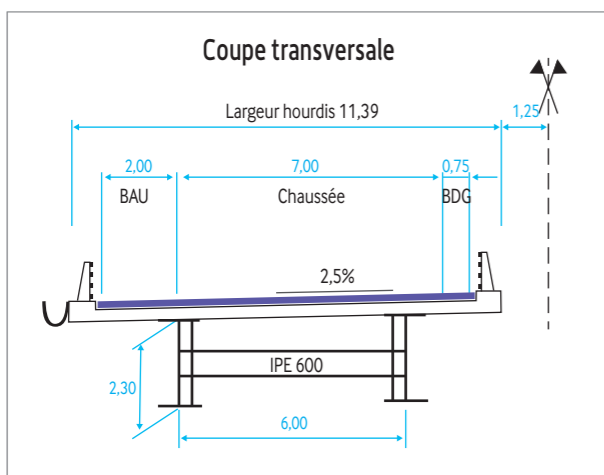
PROFIL EN TRAVERS AU NIVEAU D'UN OUVRAGE D'ART NON COURANT
